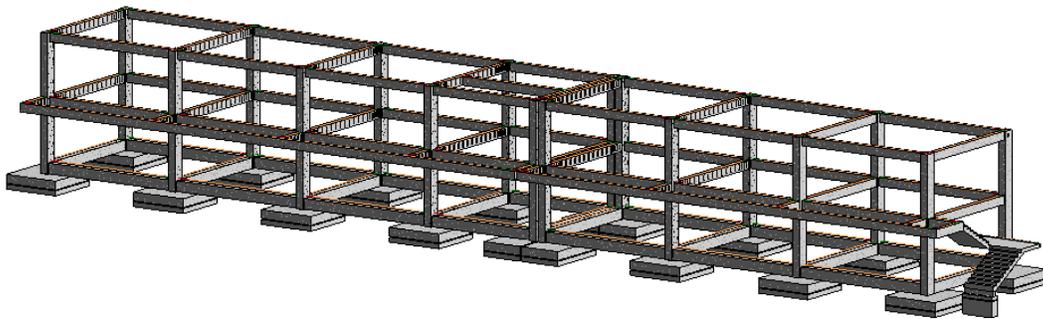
Modelado 4D estructural bloque 2 con información definitiva de concreto y ciclópeo.
